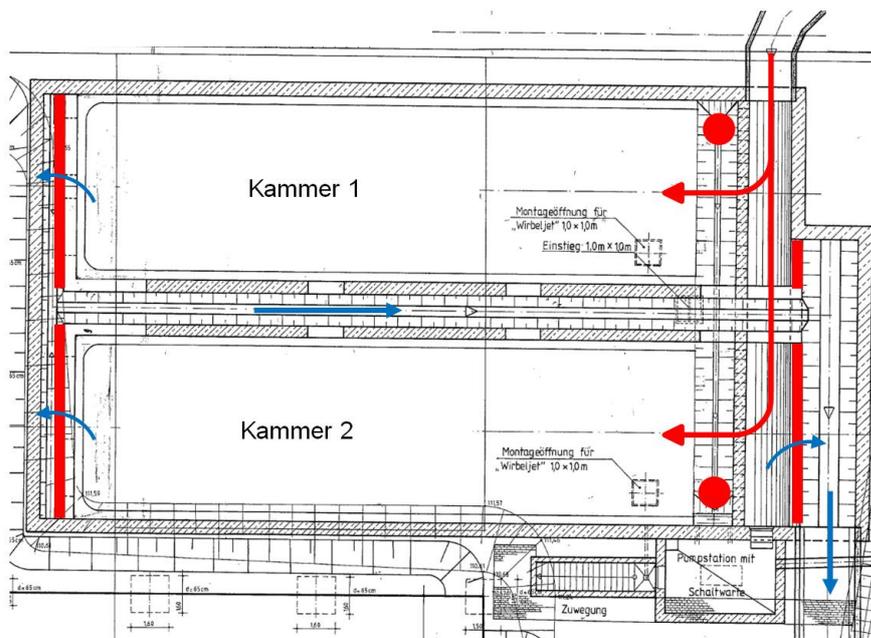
Grundriss des RÜB „Zwei Kammern“ aus Planunterlagen
